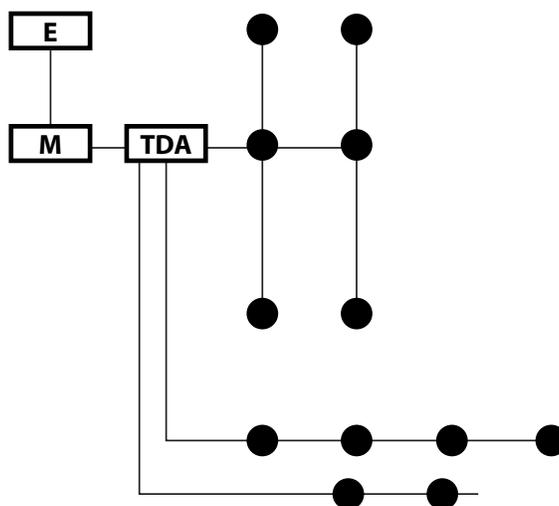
Figura XX. Esquema de canalización en EMT (tubería metálica rígida)
